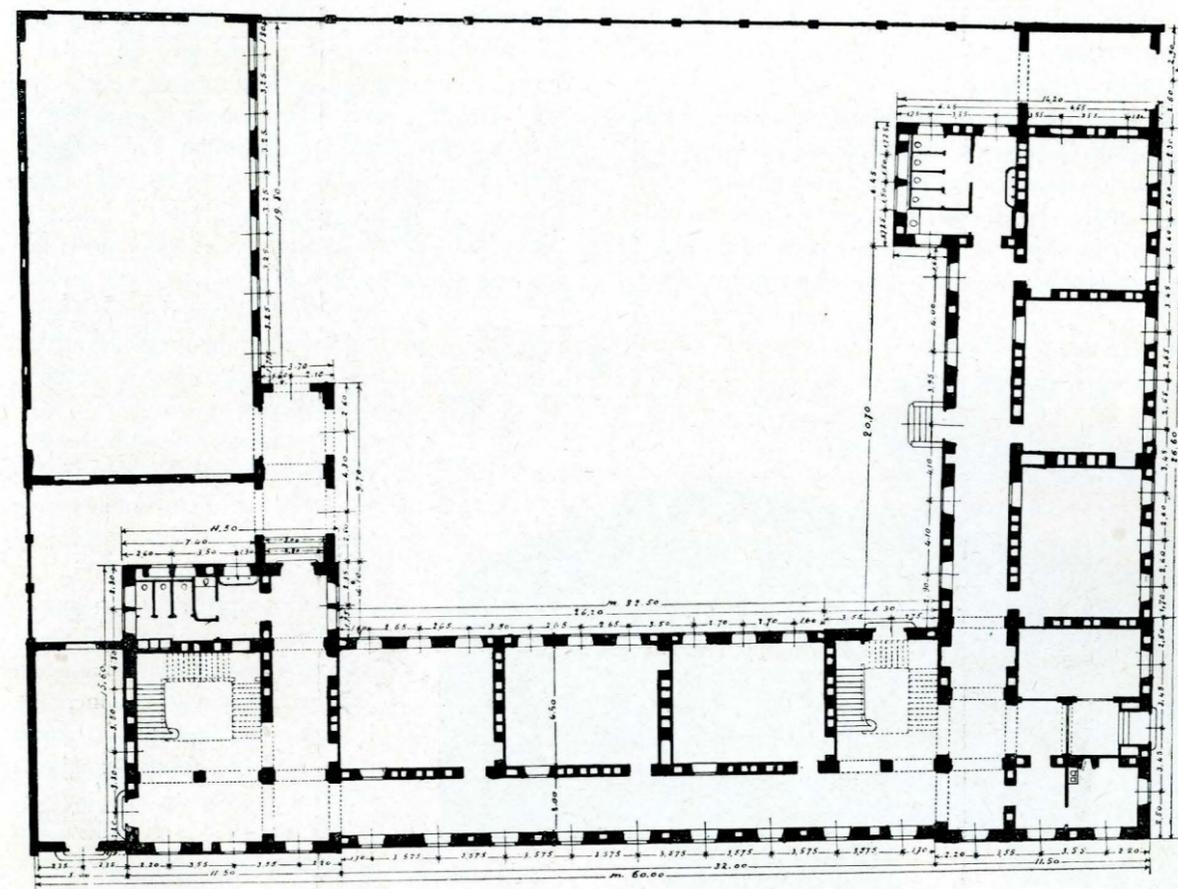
Pianta del piano terreno. — Scala 1 : 400.
